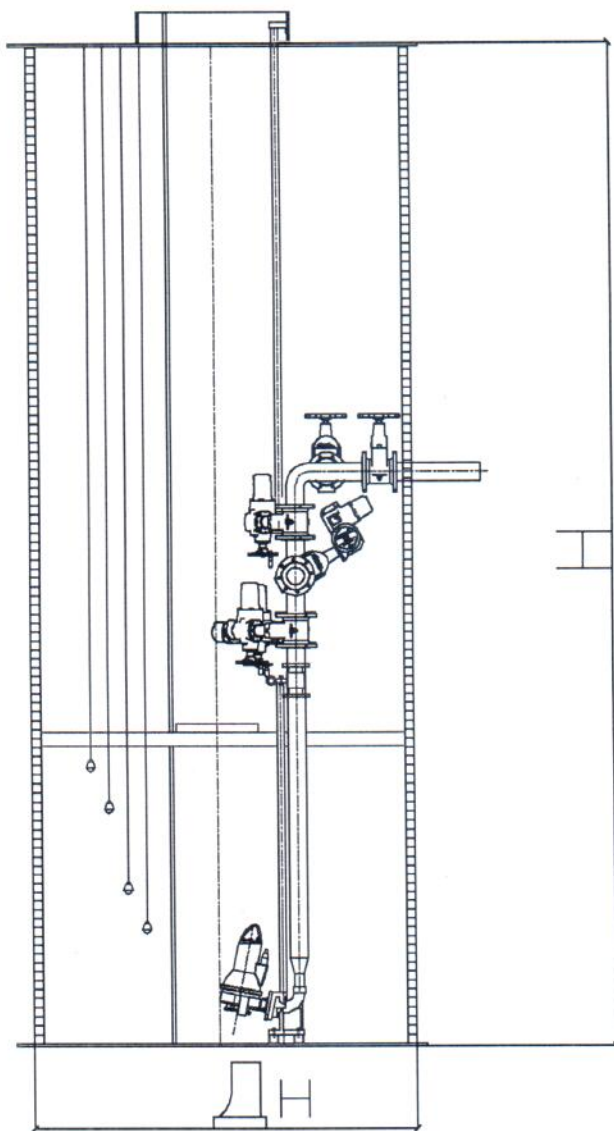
Общий вид комплектной насосной установки НС в корпусе из пластика или стеклопластика торговой марки «Tauber».
